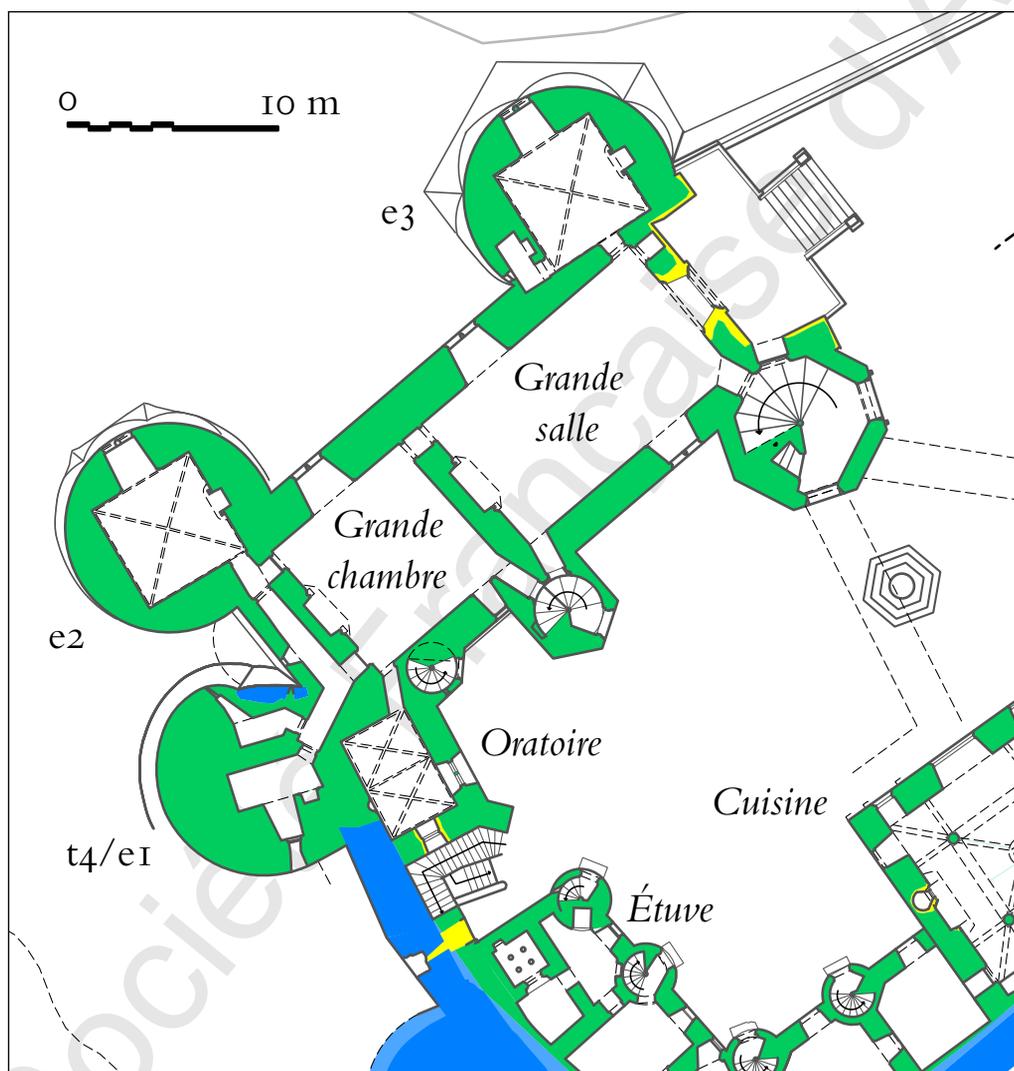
Montreuil-Bellay, château, plan détaillé du rez-de-chaussée du logis neuf (dessin J. Mesqui 2022).
